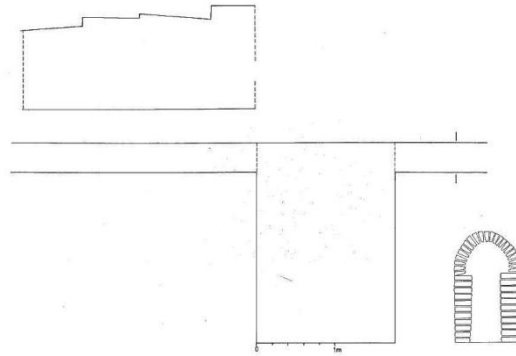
Planta y secciones de las galerías subterráneas de La Fuente Vieja (GARCÍA Y RUFETE, 1996).
